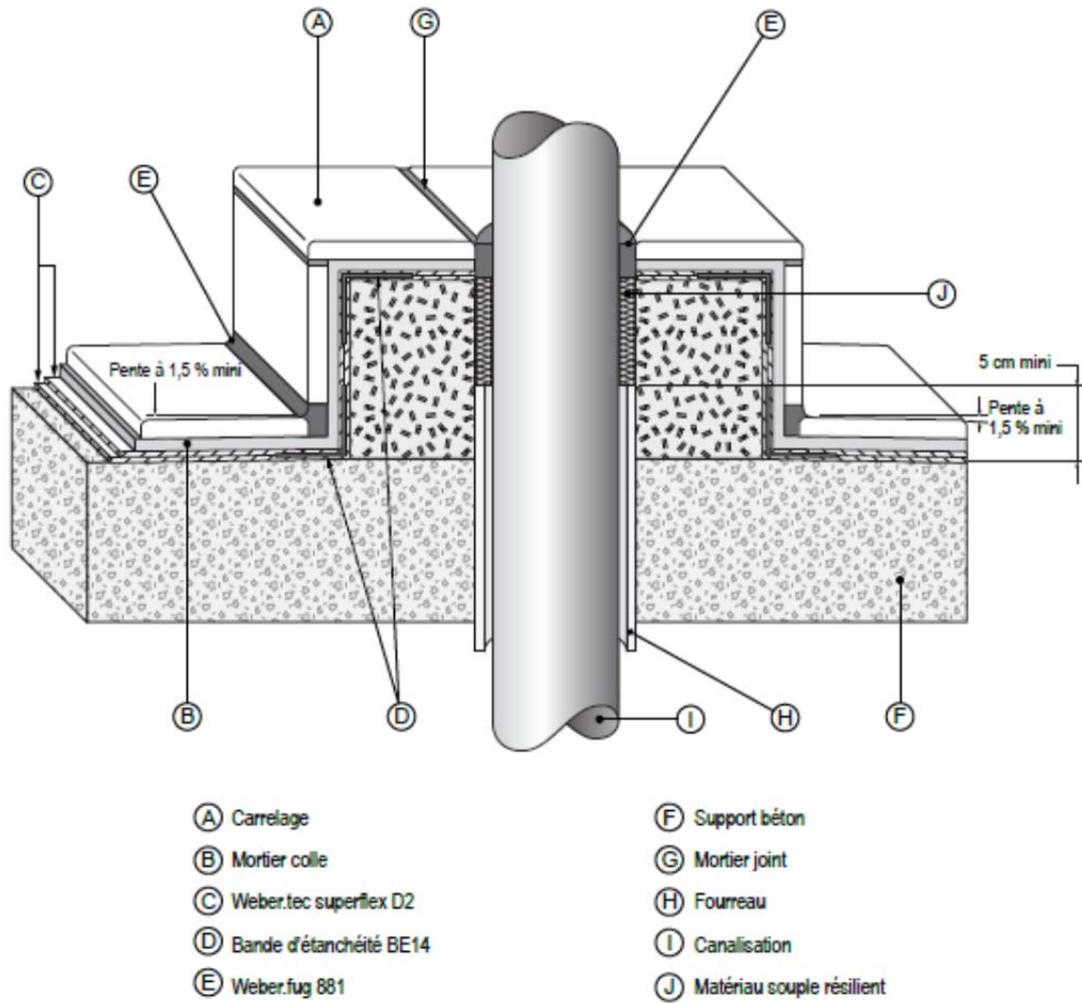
Traitement d'une canalisation traversante en sol – cas de la pose collée de carrelage
